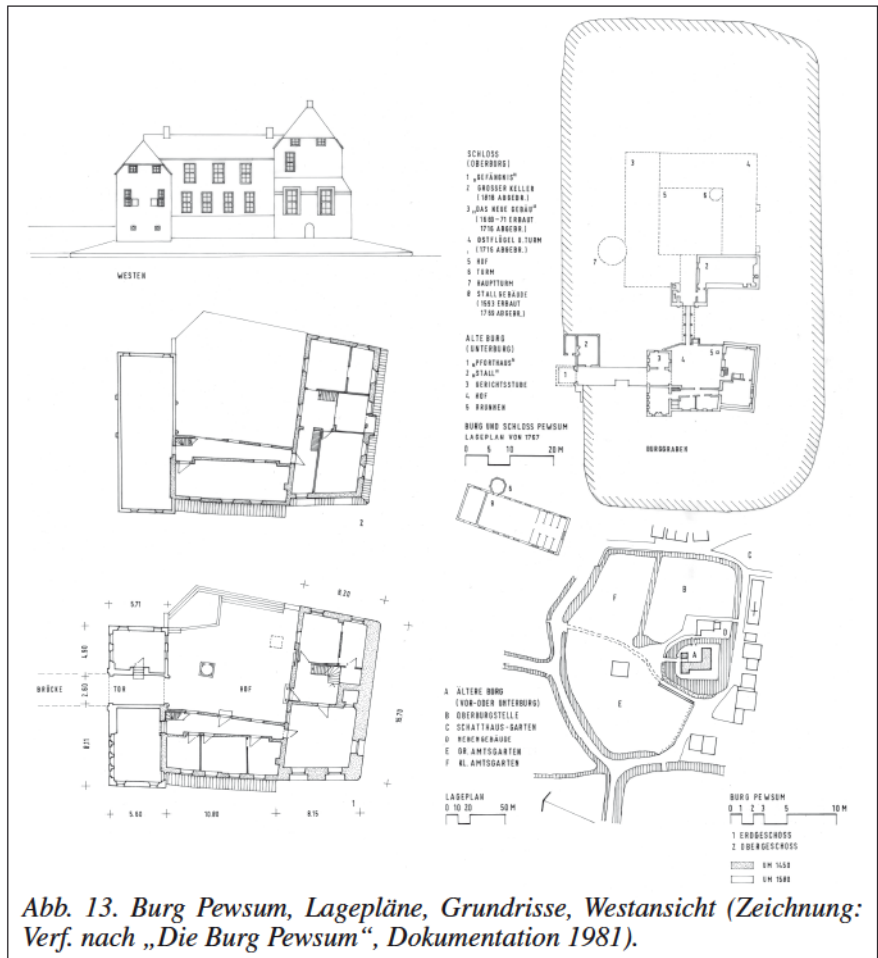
Burg Pewsum, Lagepläne, Grundrisse, Westansicht (Zeichnung: Verf. nach „Die Burg Pewsum“, Dokumentation 1981).
